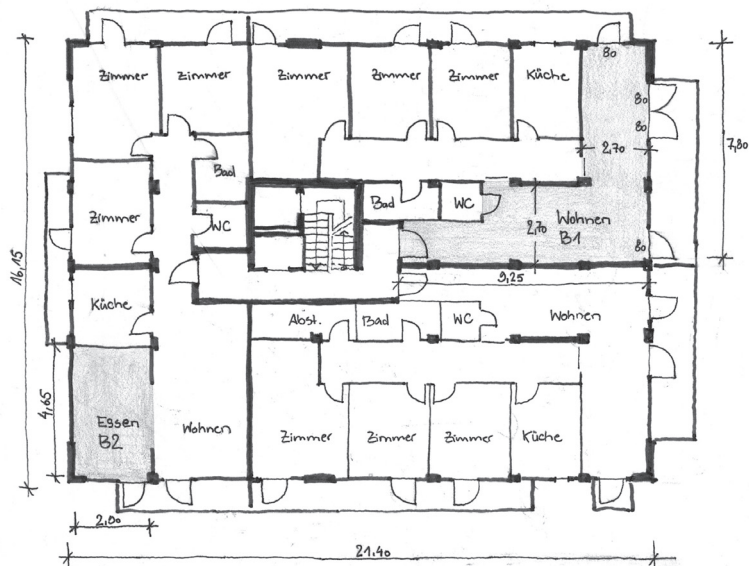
Beispielgebäude B, Grundriss 1. Geschoss
